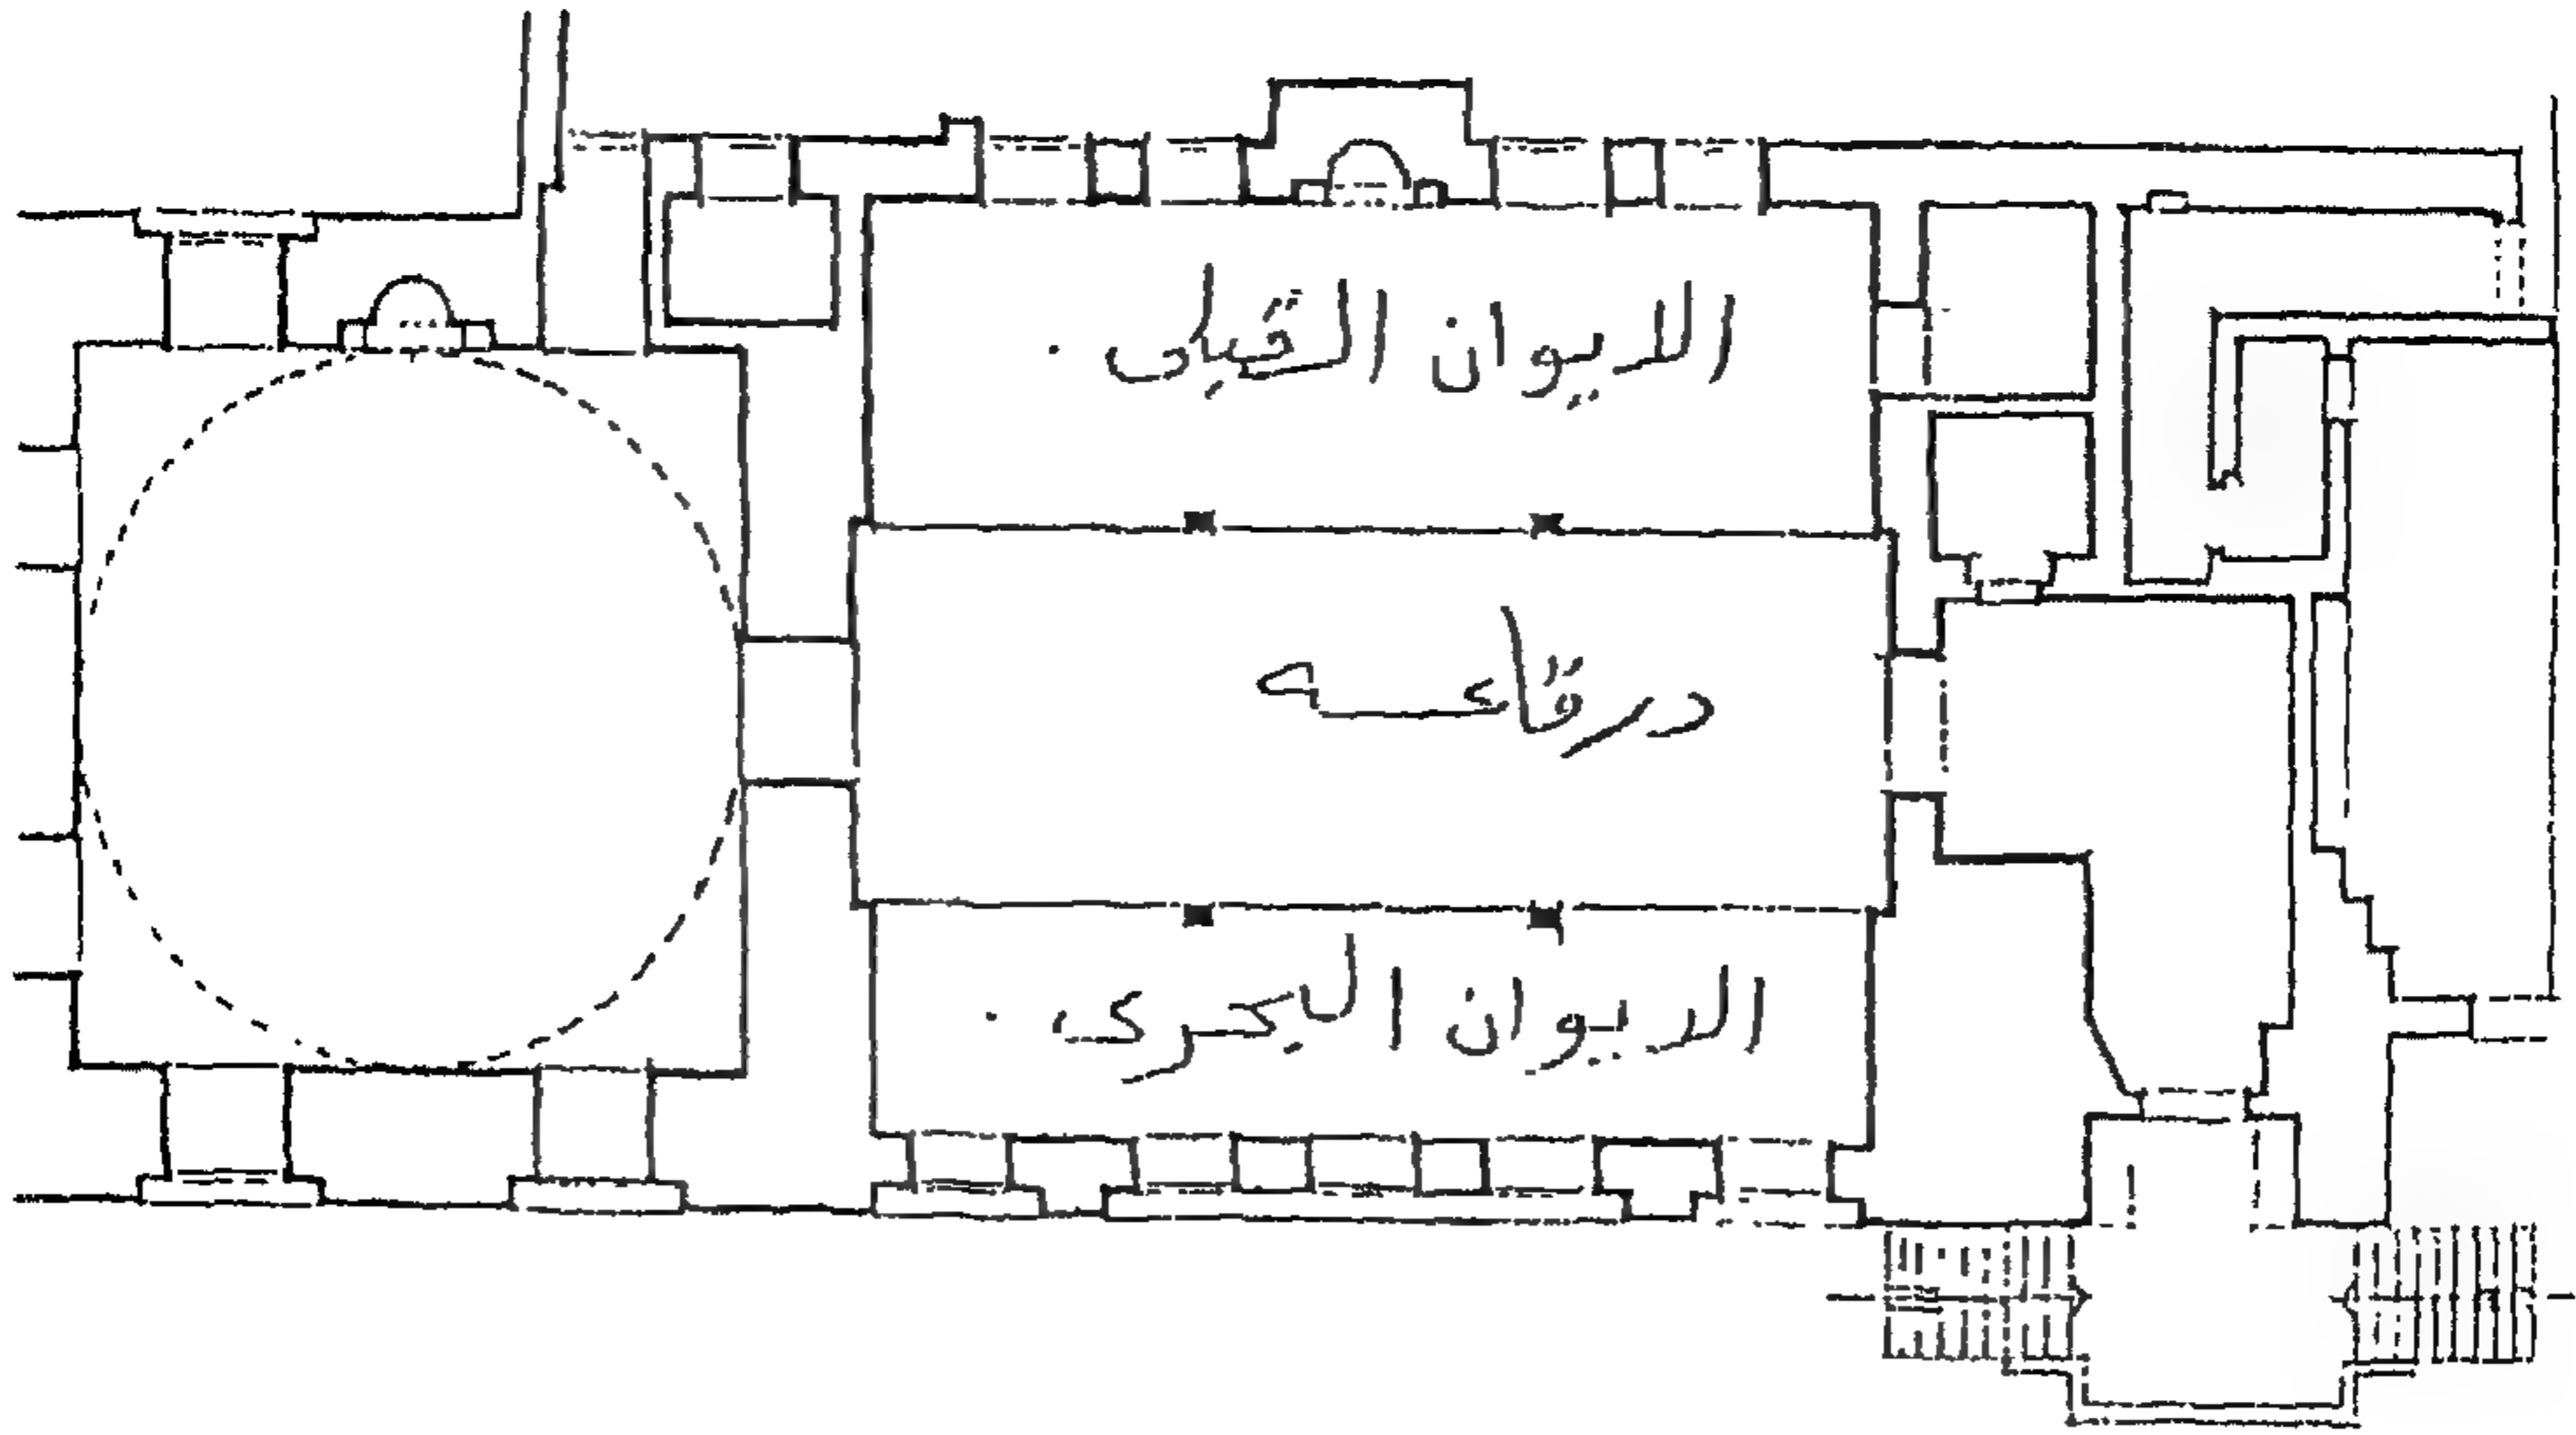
مسقط أفقي لخانة الناصر فرج بن برقوق بقرافة
